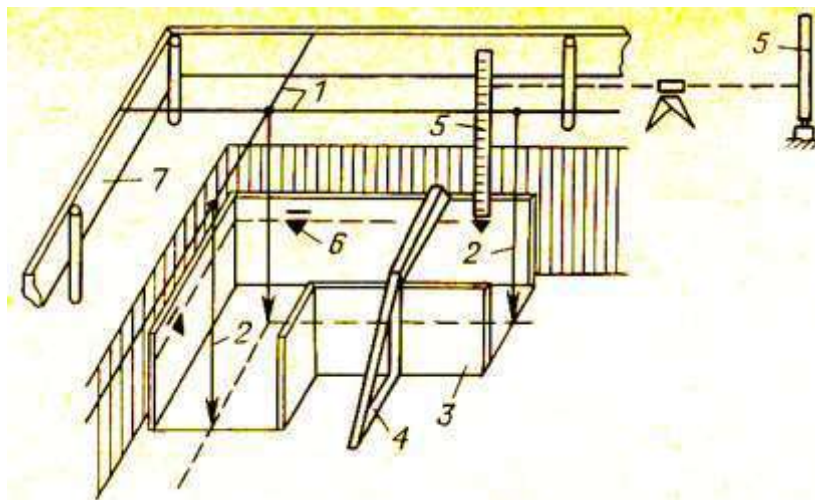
Схема установки опалубки под монолитные фундаменты: 1 – проволочные струны; 2 – отвесы; 3 – щиты опалубки; 4 – крепежные элементы; 5 – мерная рейка; 6 – отметка бетонирования; 7 – обноска
